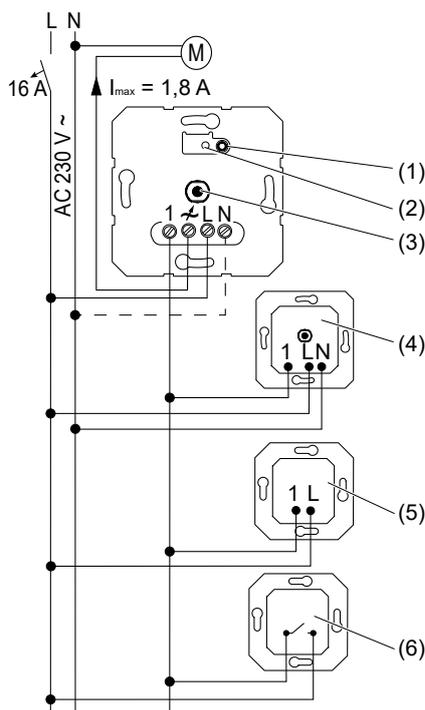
Plan de conexión con mecanismos auxiliares opcionales
